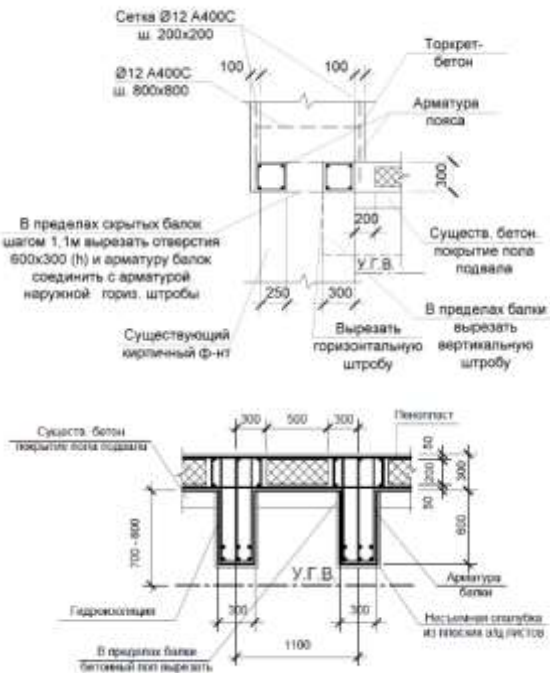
Детали устройства монолитных монолитных фундаментных плит усиления и усиления стен подвала
